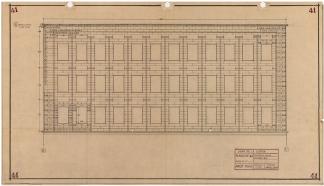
y 5b. Patronato Juan de la Cierva. Axonometría y alzado de proyecto. Madrid, 1949-50. Fundación Fisac.
